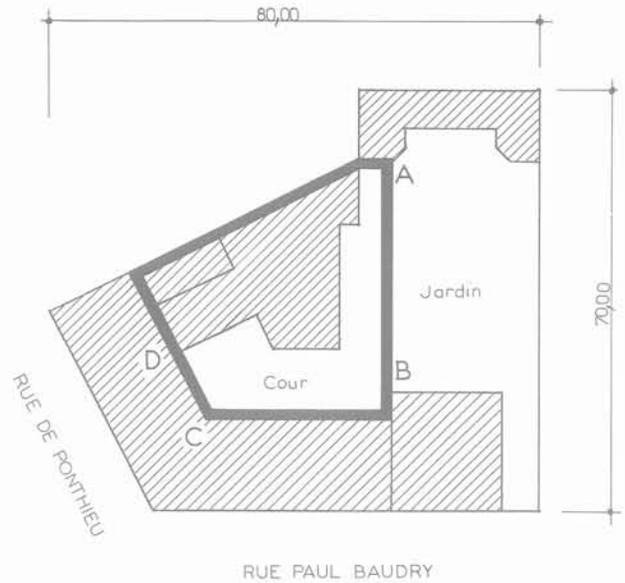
Paris 8<sup>e</sup>. Rue Paul-Baudry. Plan.
